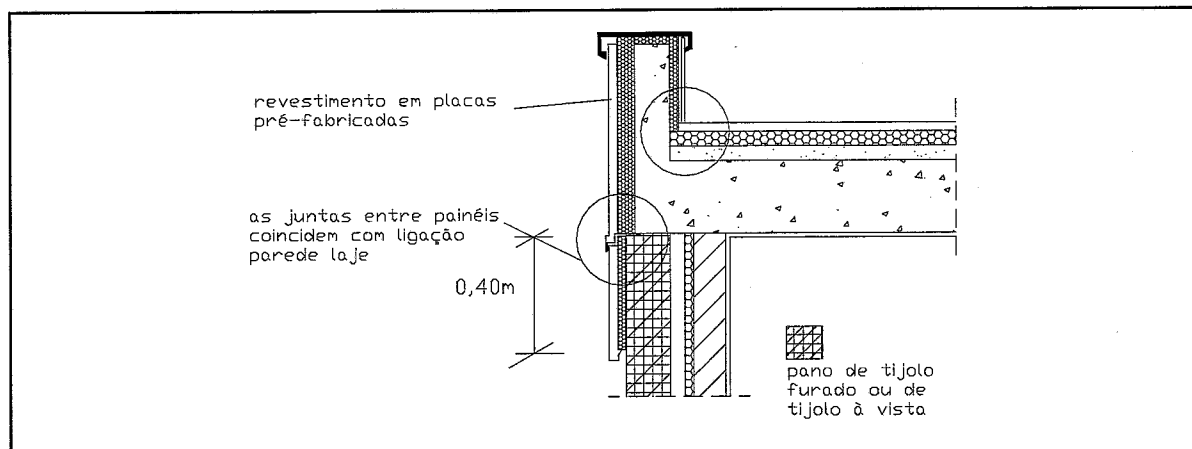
Pormenor da aplicação de placas prefabricadas revestimento/isolante na ligação entre laje de cobertura e parede exterior
